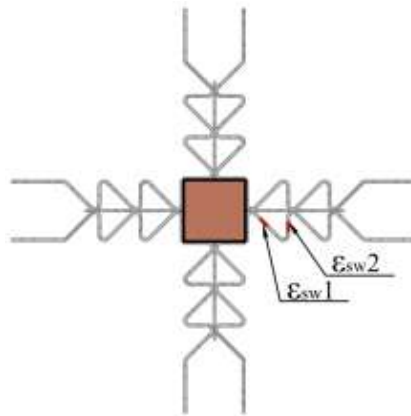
Disposição do ϵ_{sw2} nas armaduras de cisalhamento da laje L2.
